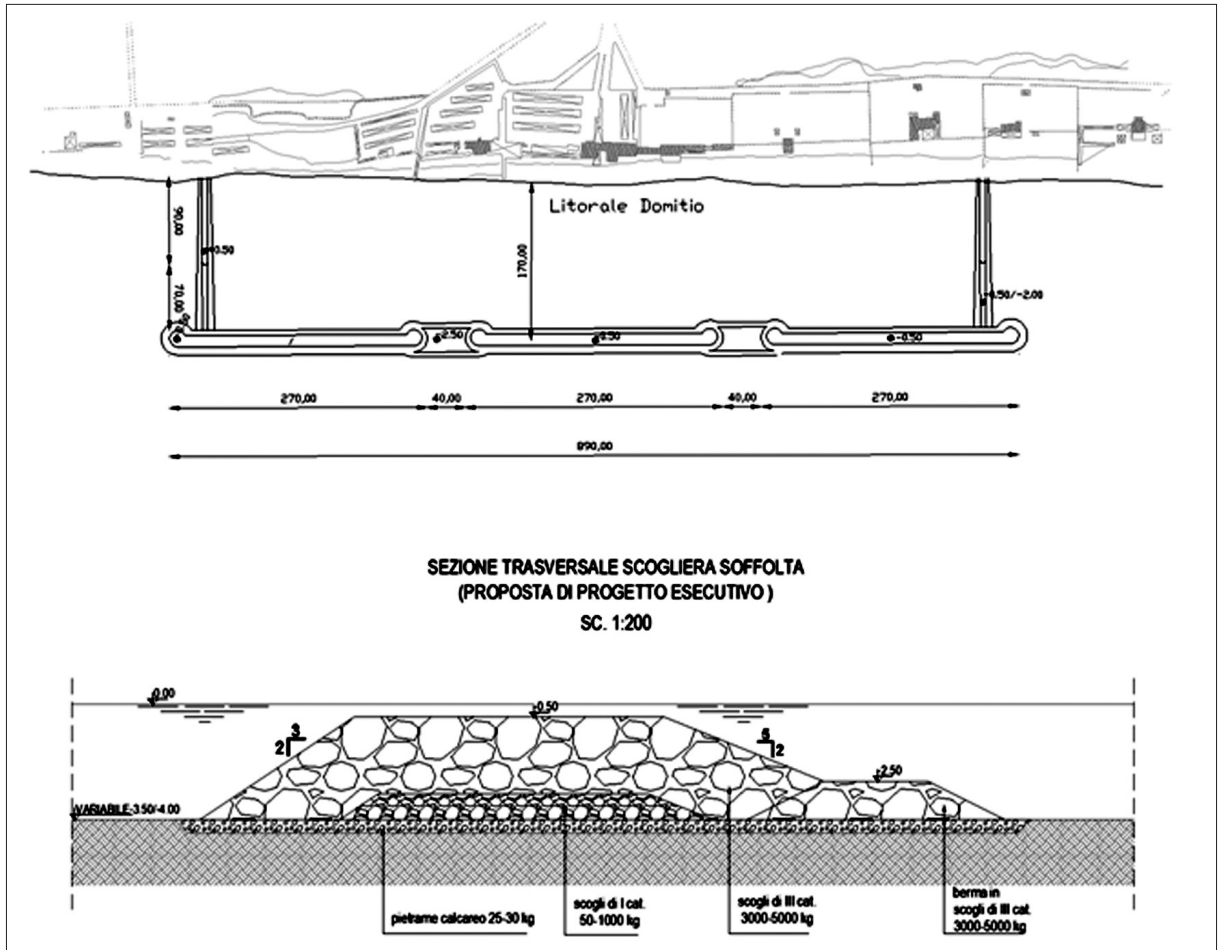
Planimetria dell'opera di protezione e sezione tipo della scogliera soffolta.
